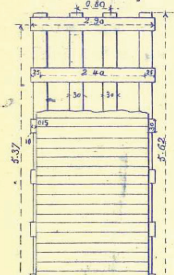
Pont de Bouchemaine sur la Maine. Caisson sur pieux.
